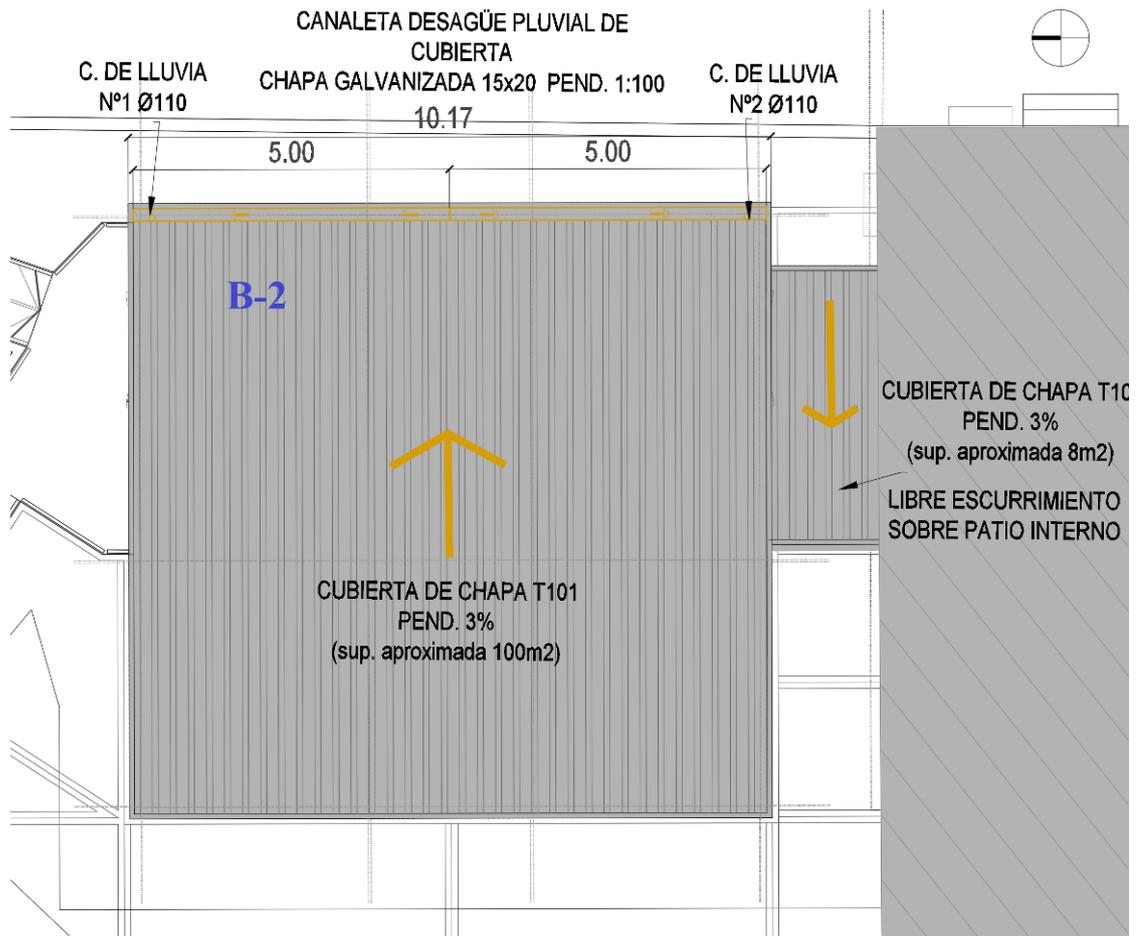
Planta de techos, Edificio B-2 a desaguar en paso fronterizo La Quiaca - Provincia de Jujuy
